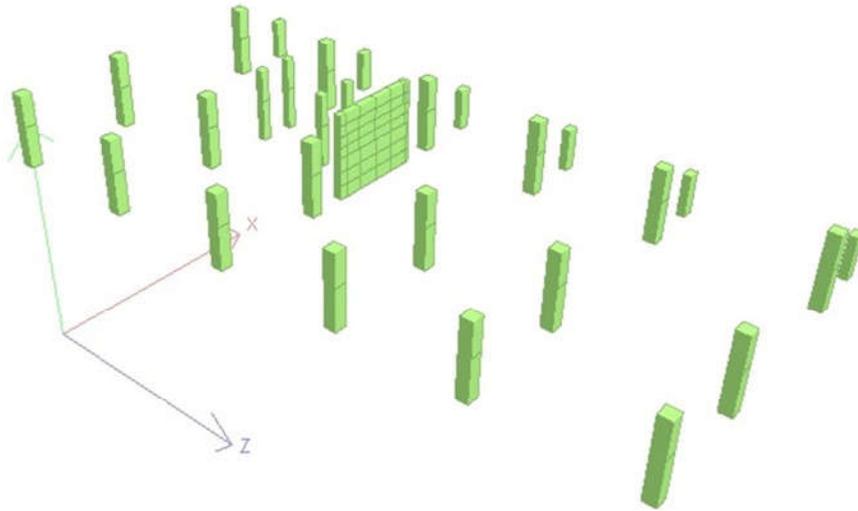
Render hasil potongan berat bangunan lantai 3
